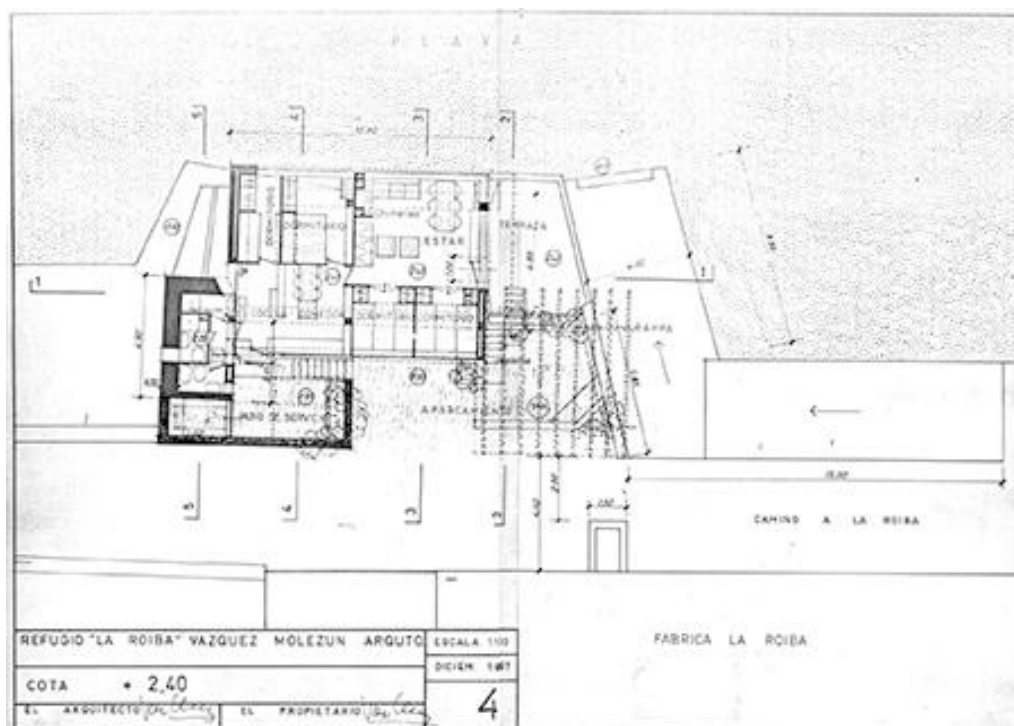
Molezún. La Roiba. Planta baja. Proyecto de ejecución. Julio 1967
